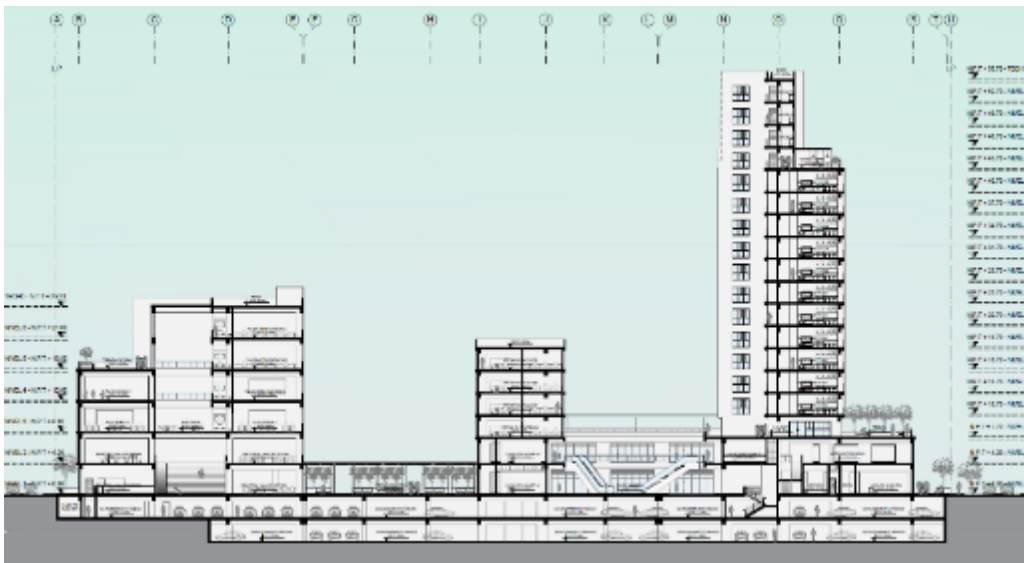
Corte C-C' longitudinal.Nota. Creación propia (2023)*Figura 100*Corte D-D' transversal.*Figura 101*Corte E-E' transversal.Nota. Creación propia (2023).
